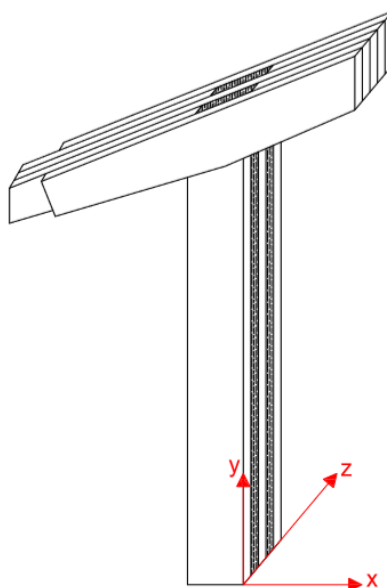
Sistemas de coordenadas global adotado para o projeto.
